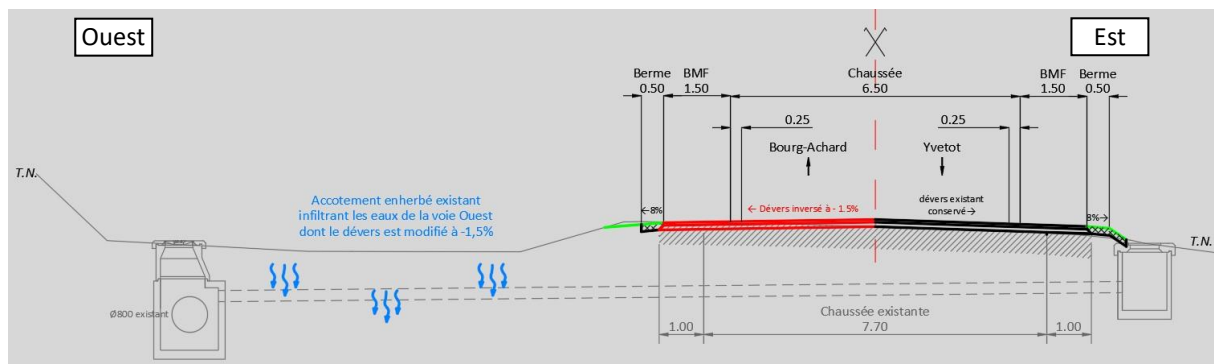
Reprofilage de la demi-chaussée Ouest et zone d'infiltration
